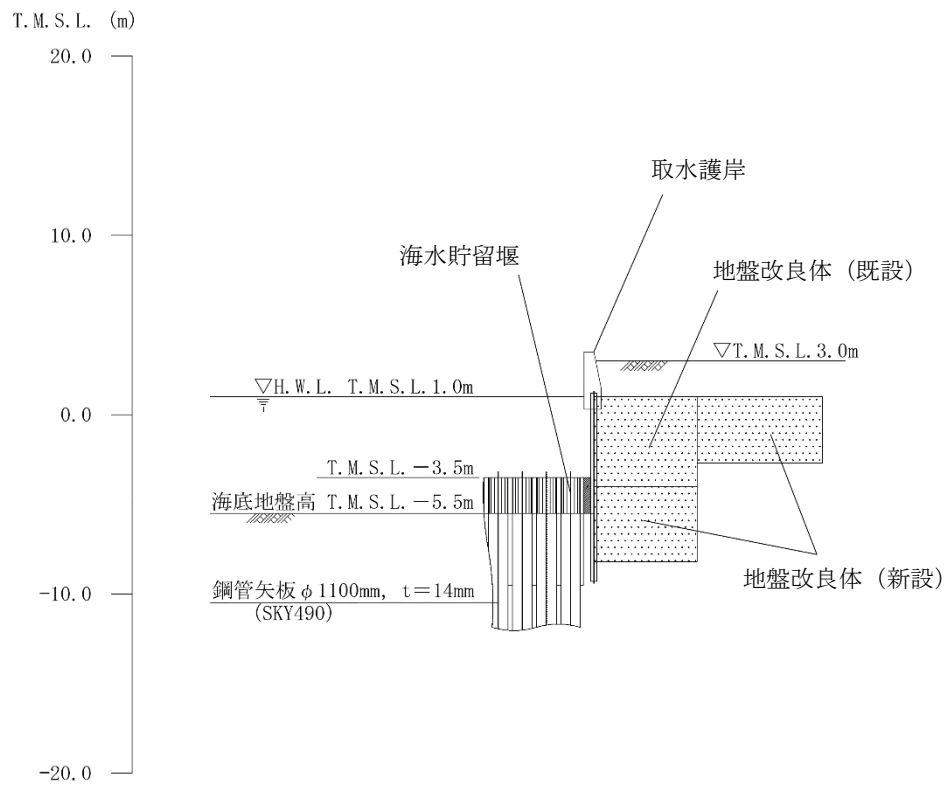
取水護岸の標準断面図 (A-A断面)
